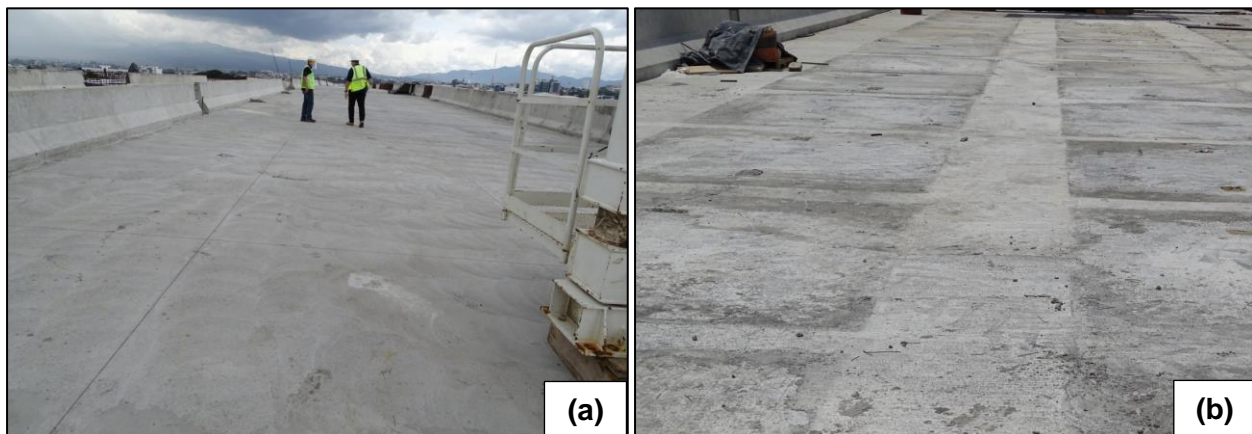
Dos tipos de construcción para las losas del tablero del viaducto. (a) Losas coladas en sitio.
